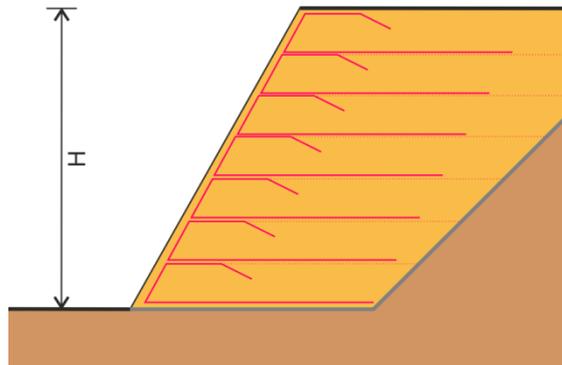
Schnitt einer Bewehrte Erde Konstruktion
